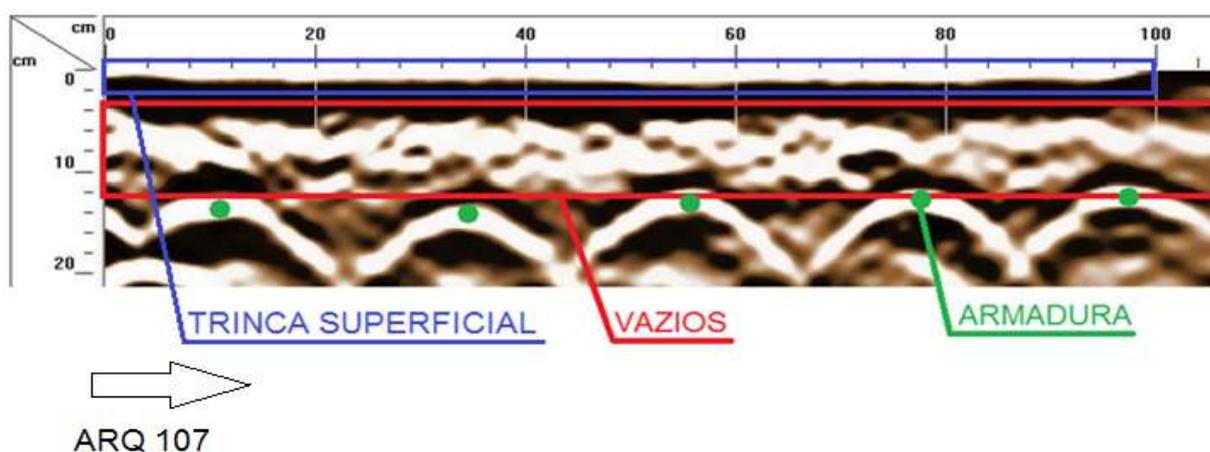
Leitura de escaneamento por radar em local com fissura.
